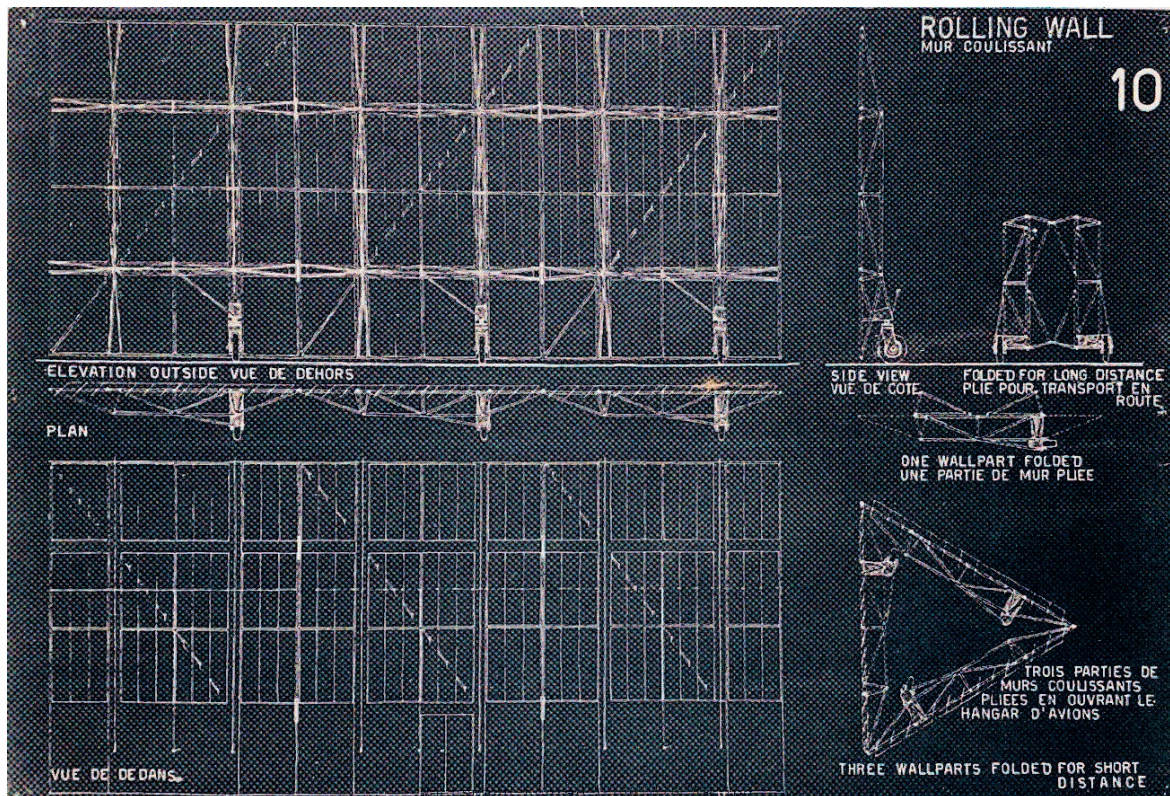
Konrad Wachsmann. *A New Method of Construction*. Lámina 10. Rolling Wall. 1939. En la lámina se aprecia como una unidad *wallpart* se puede plegar sobre sí misma en alzado y planta para transportes de larga distancia. En este dibujo a su vez se aprecia que cada parte solo cuenta con una rueda. Para recorridos cortos, normalmente en la ubicación elegida para la construcción del hangar tres unidades se pliegan formando un triángulo equilátero. Esta configuración si es estable, ya que cuenta con tres rodamientos.
